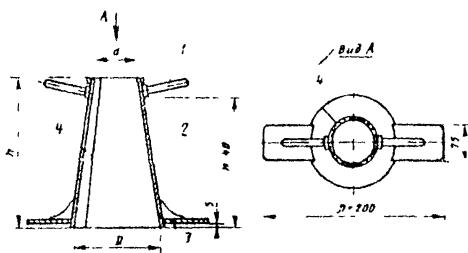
Конус для определения удобоукладываемости бетонной смеси : 1-ручка; 2-конус прибора; 3-упоры; 4-сварной шов
